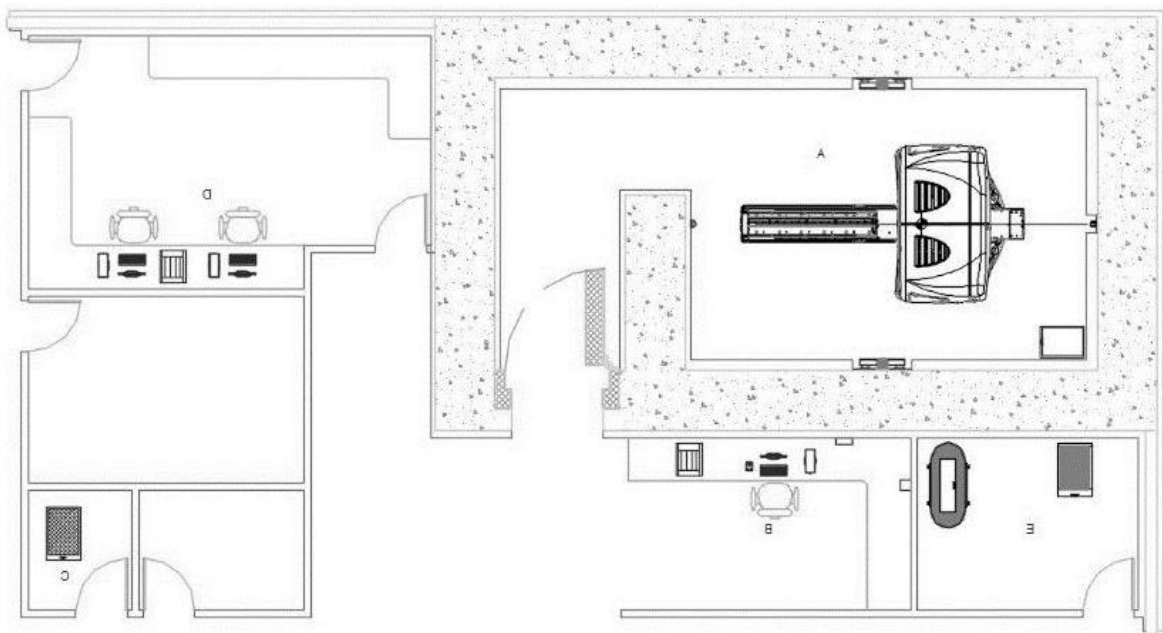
Plano de planta típico del sistema Radixact con laberinto [16].
